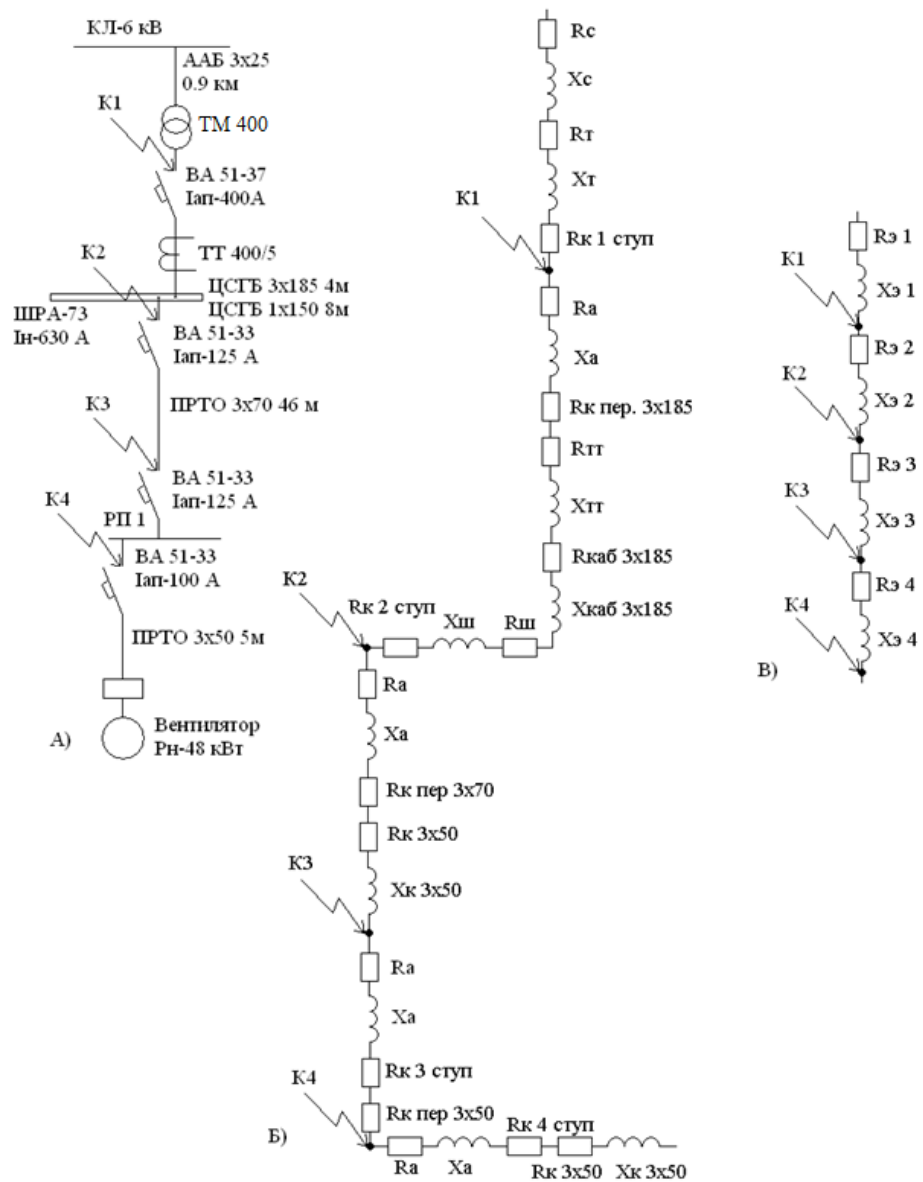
Схема электроснабжения: А) схема расчетная; Б) схема замещения; В) схема замещения упрощенная
